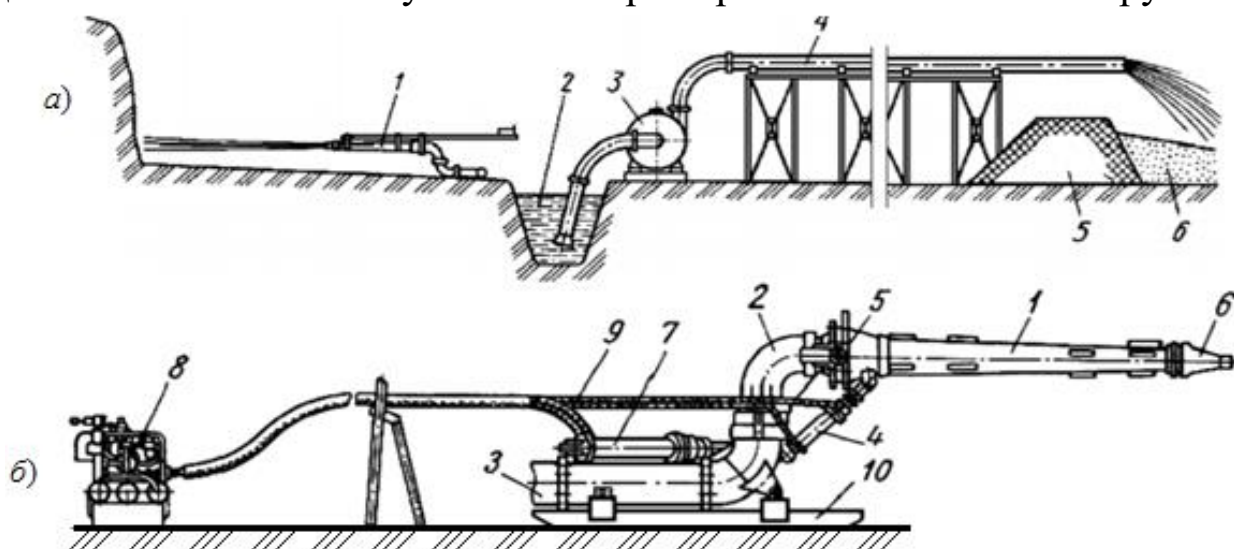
Схема разработки грунта гидромонитором (а); гидромонитор (б).
